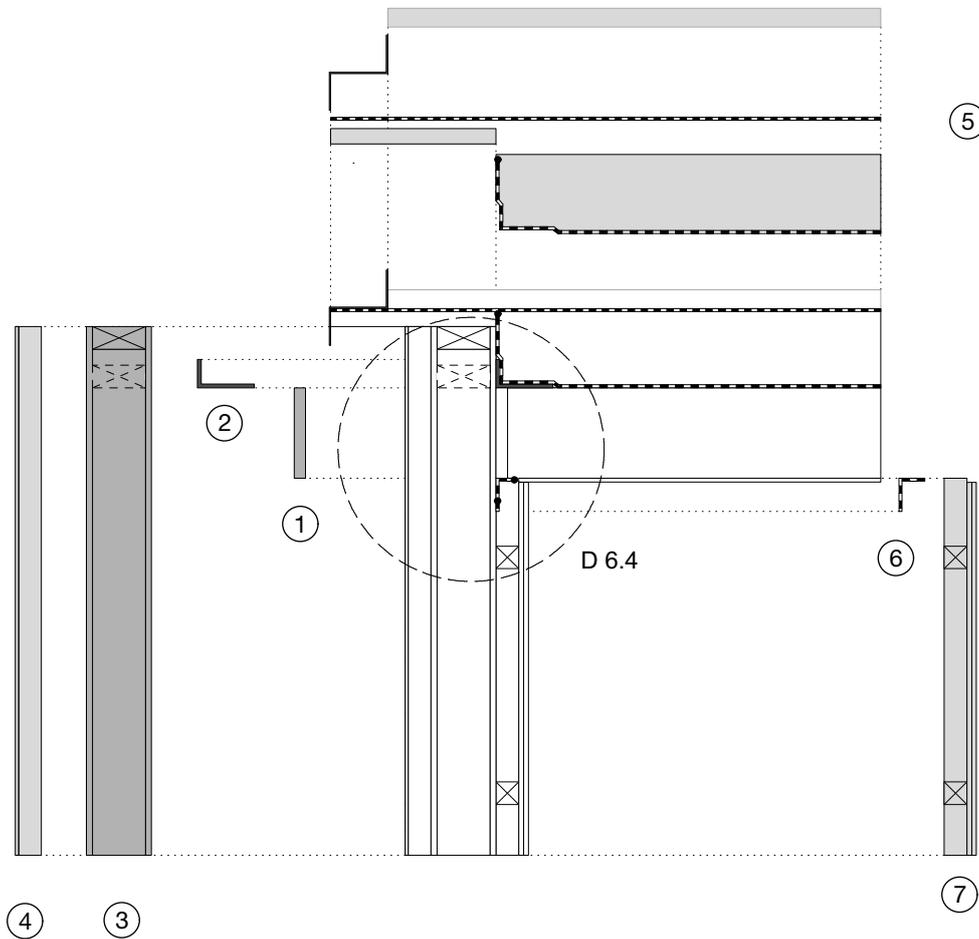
Montagereihenfolge - Anschluss Flachdach ohne Attika - Außenwand, vorgestellt
